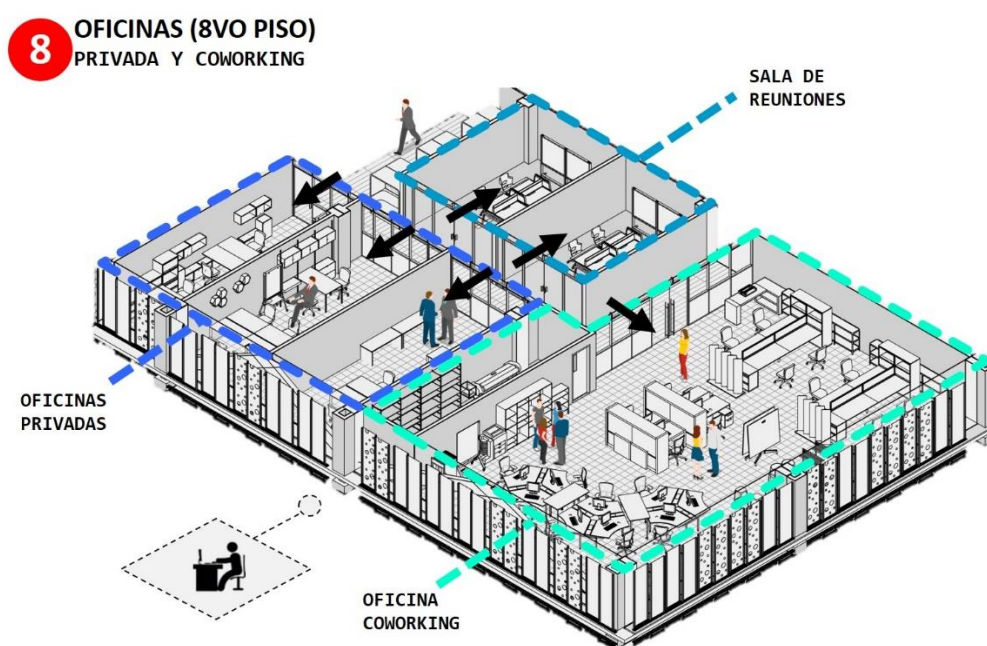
Vista de axonometría de las oficinas privadas y coworking ubicados en el octavo piso.
